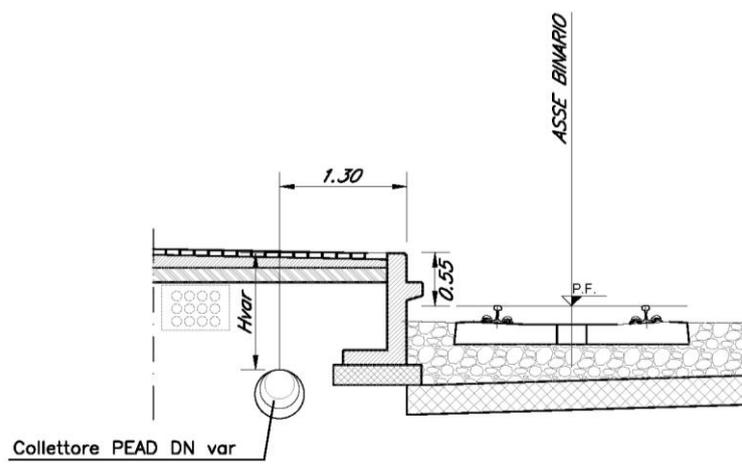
Drenaggio tra marciapiedi – Sezione corrente
